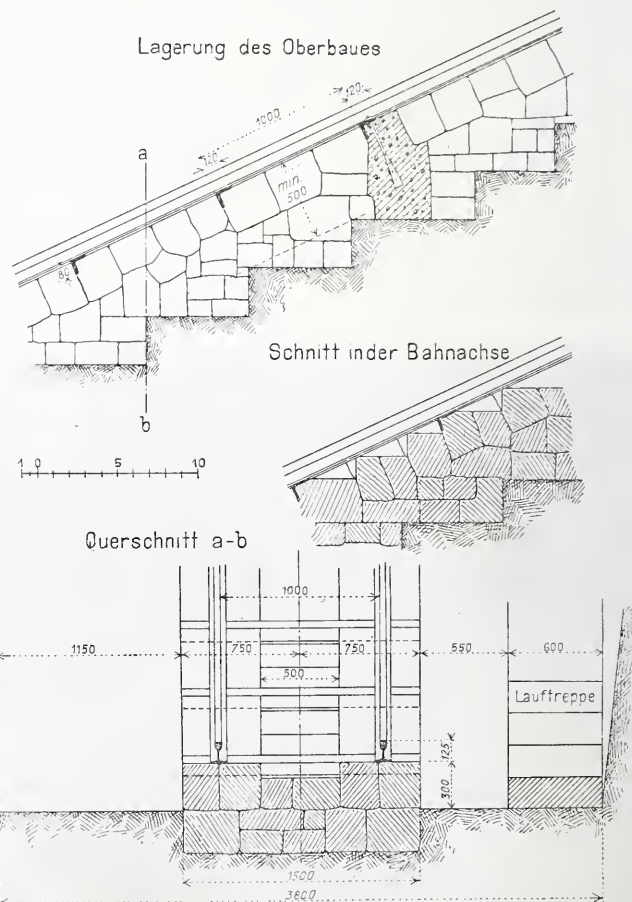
Details zum Oberbau der Seilbahnstrecke. — Masstab 1 : 50.
